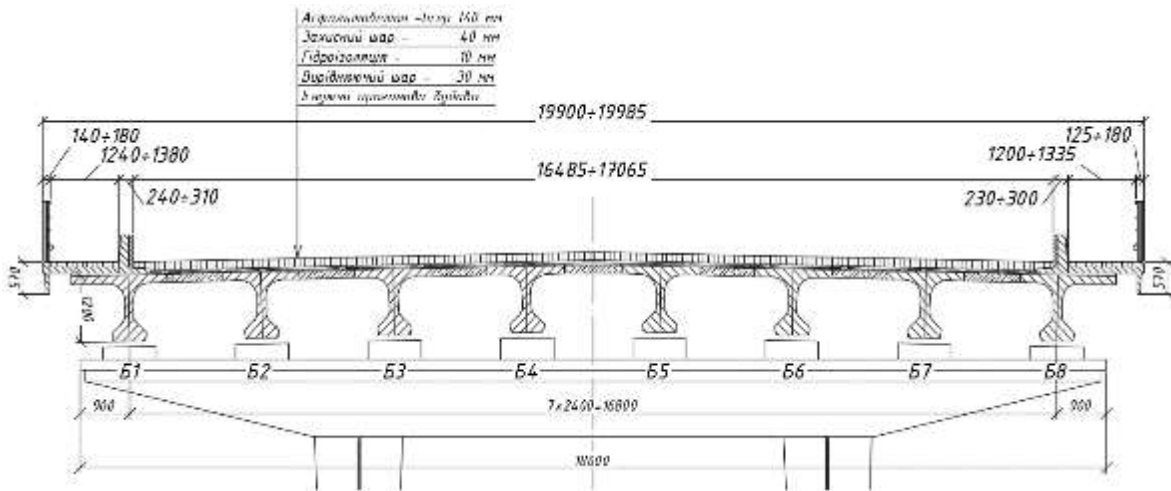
Поперечний переріз шляхопроводу до реконструкції
